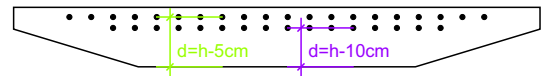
Definierte Lage der Hauptbiegezugbewehrung und der Zulagen im Stützquerschnitt
